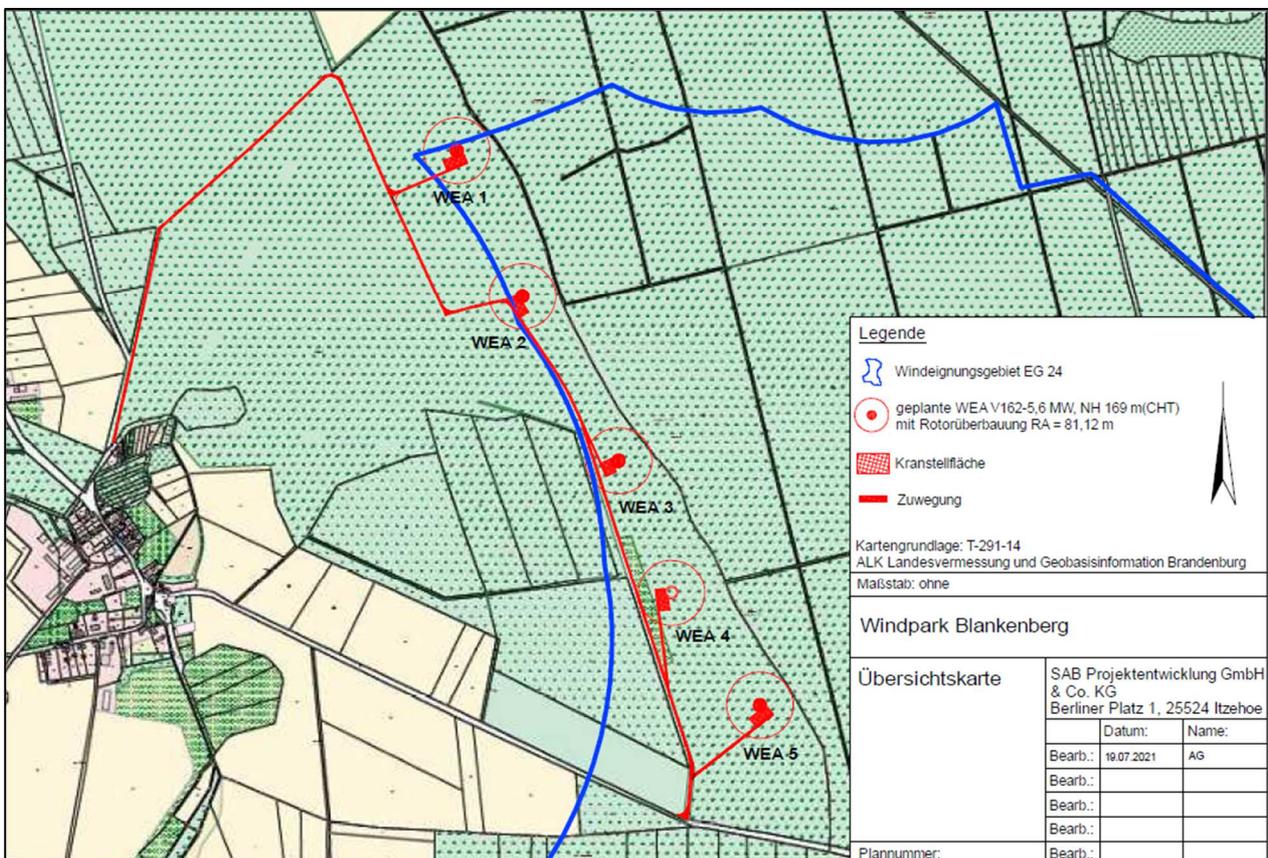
Lageplan WP Blankenberg interne Zuwegung
